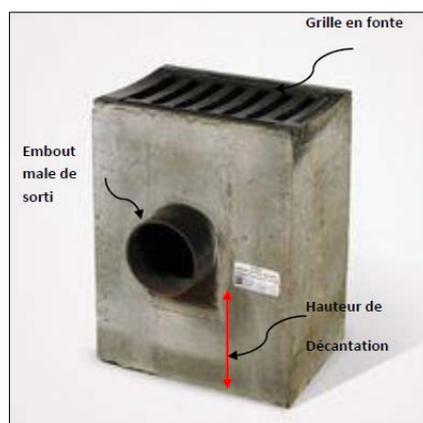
Nomenclature d'un ouvrage avaloir simple
